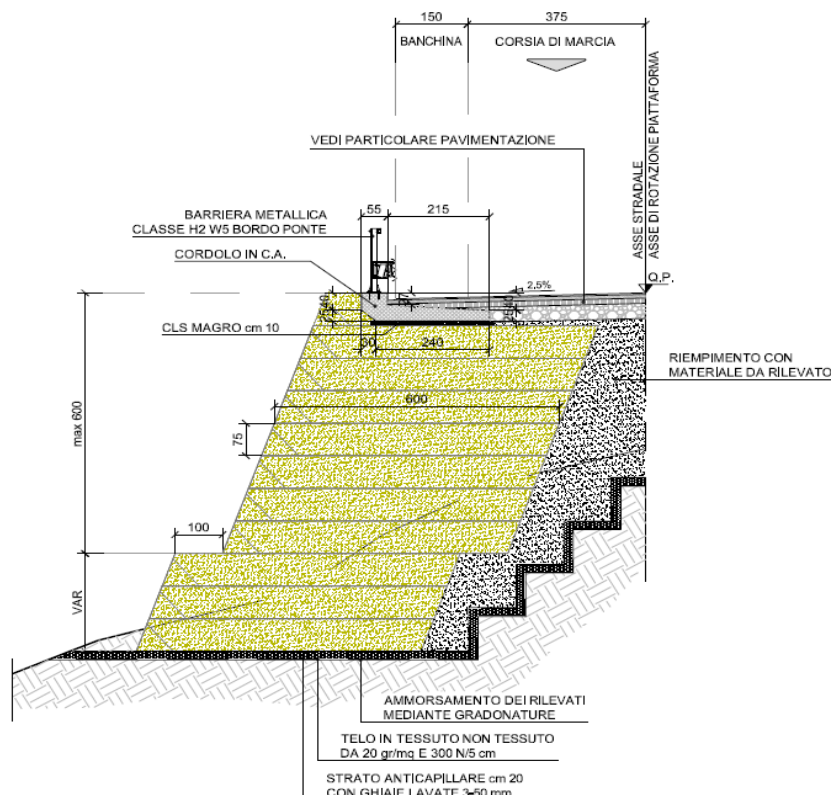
Particolare sezione stradale tipo con interventi di sostegno a valle: terre rinforzate (terramesh)
